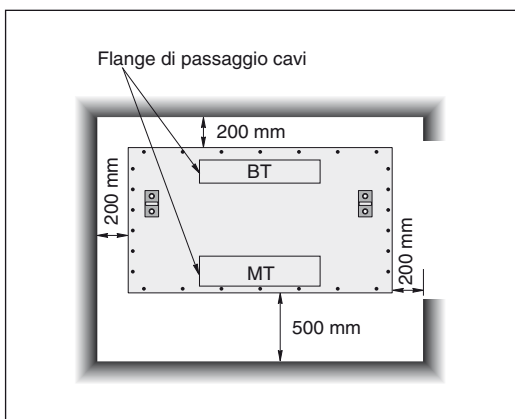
distanze minime per esecuzione con armadio di protezione IP31.
